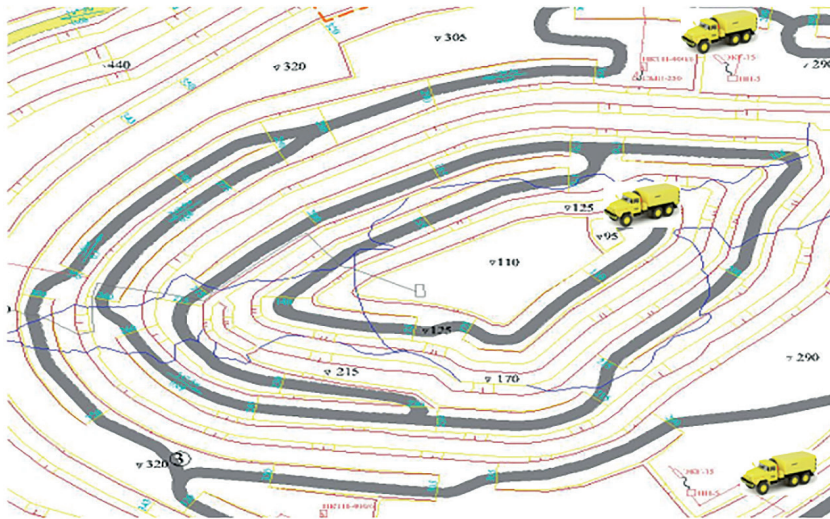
Расположение установок УМП-1Б на плане горных работ карьера
